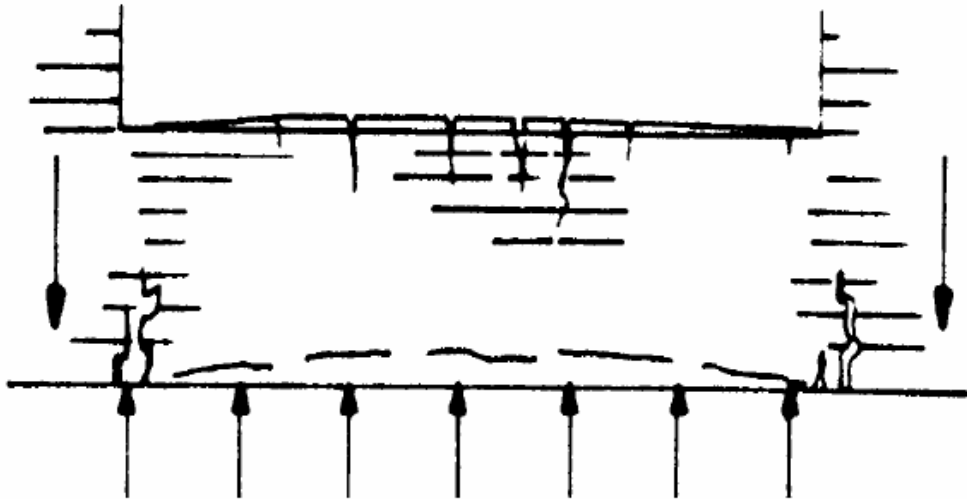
fissuração por cargas diferenciais na fundação
